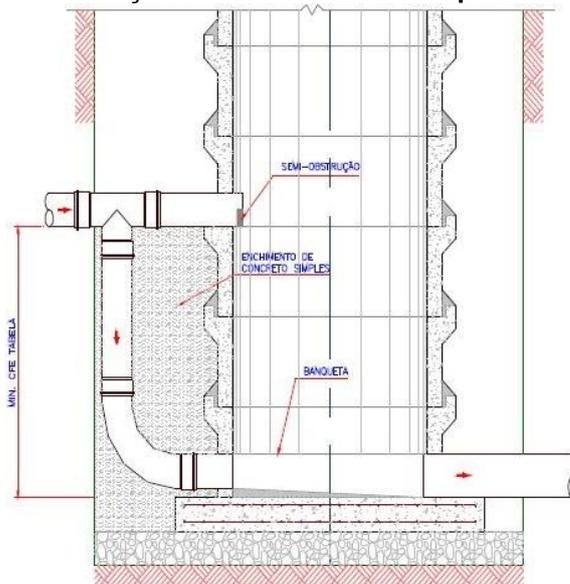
Poço de visita com balão e chaminé, em tubos de concreto armado,
